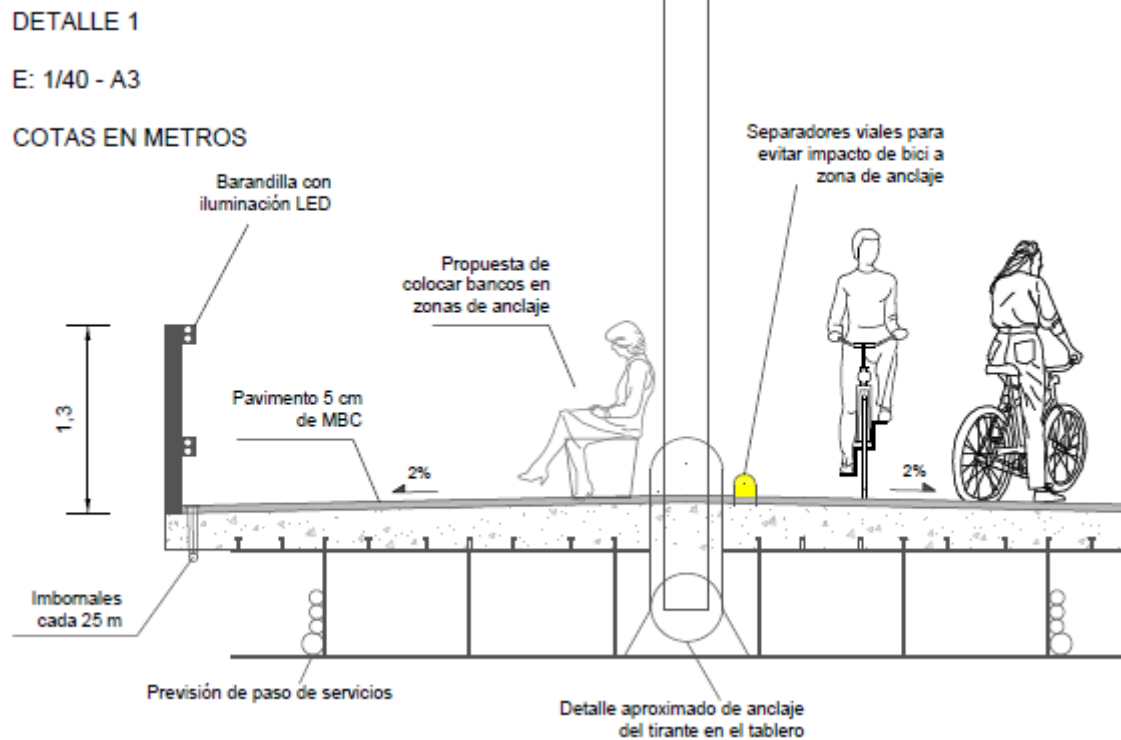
Detalle de la sección transversal del tablero. Alternativa 3 (Fuente: Elaboración propia).
